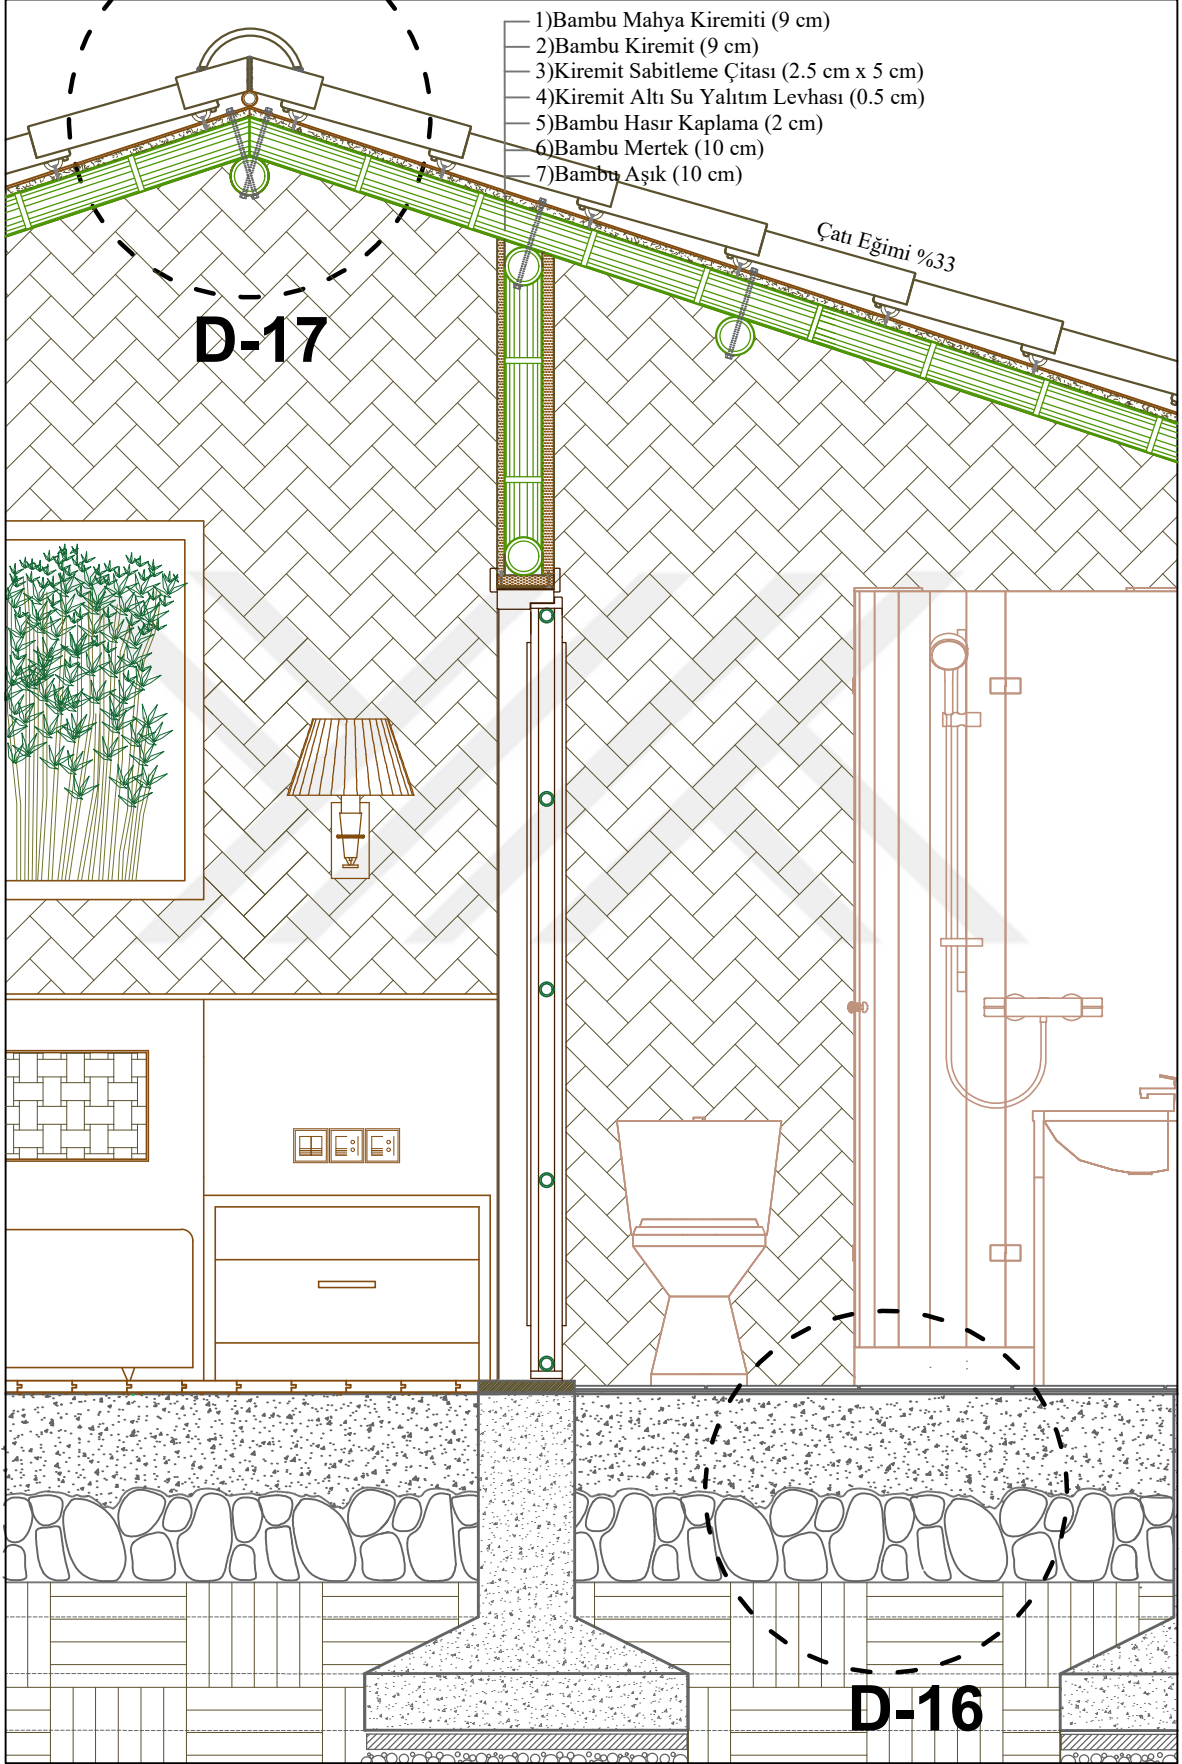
Bambu modelin sistem görünüşü ölçek:1/20
